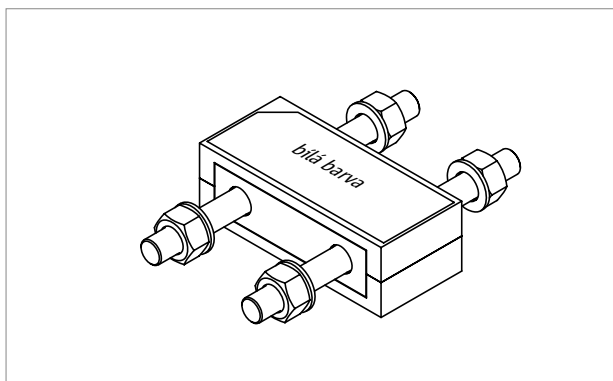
Schöck Isokorb® T typ S-N-D16: Pohled
